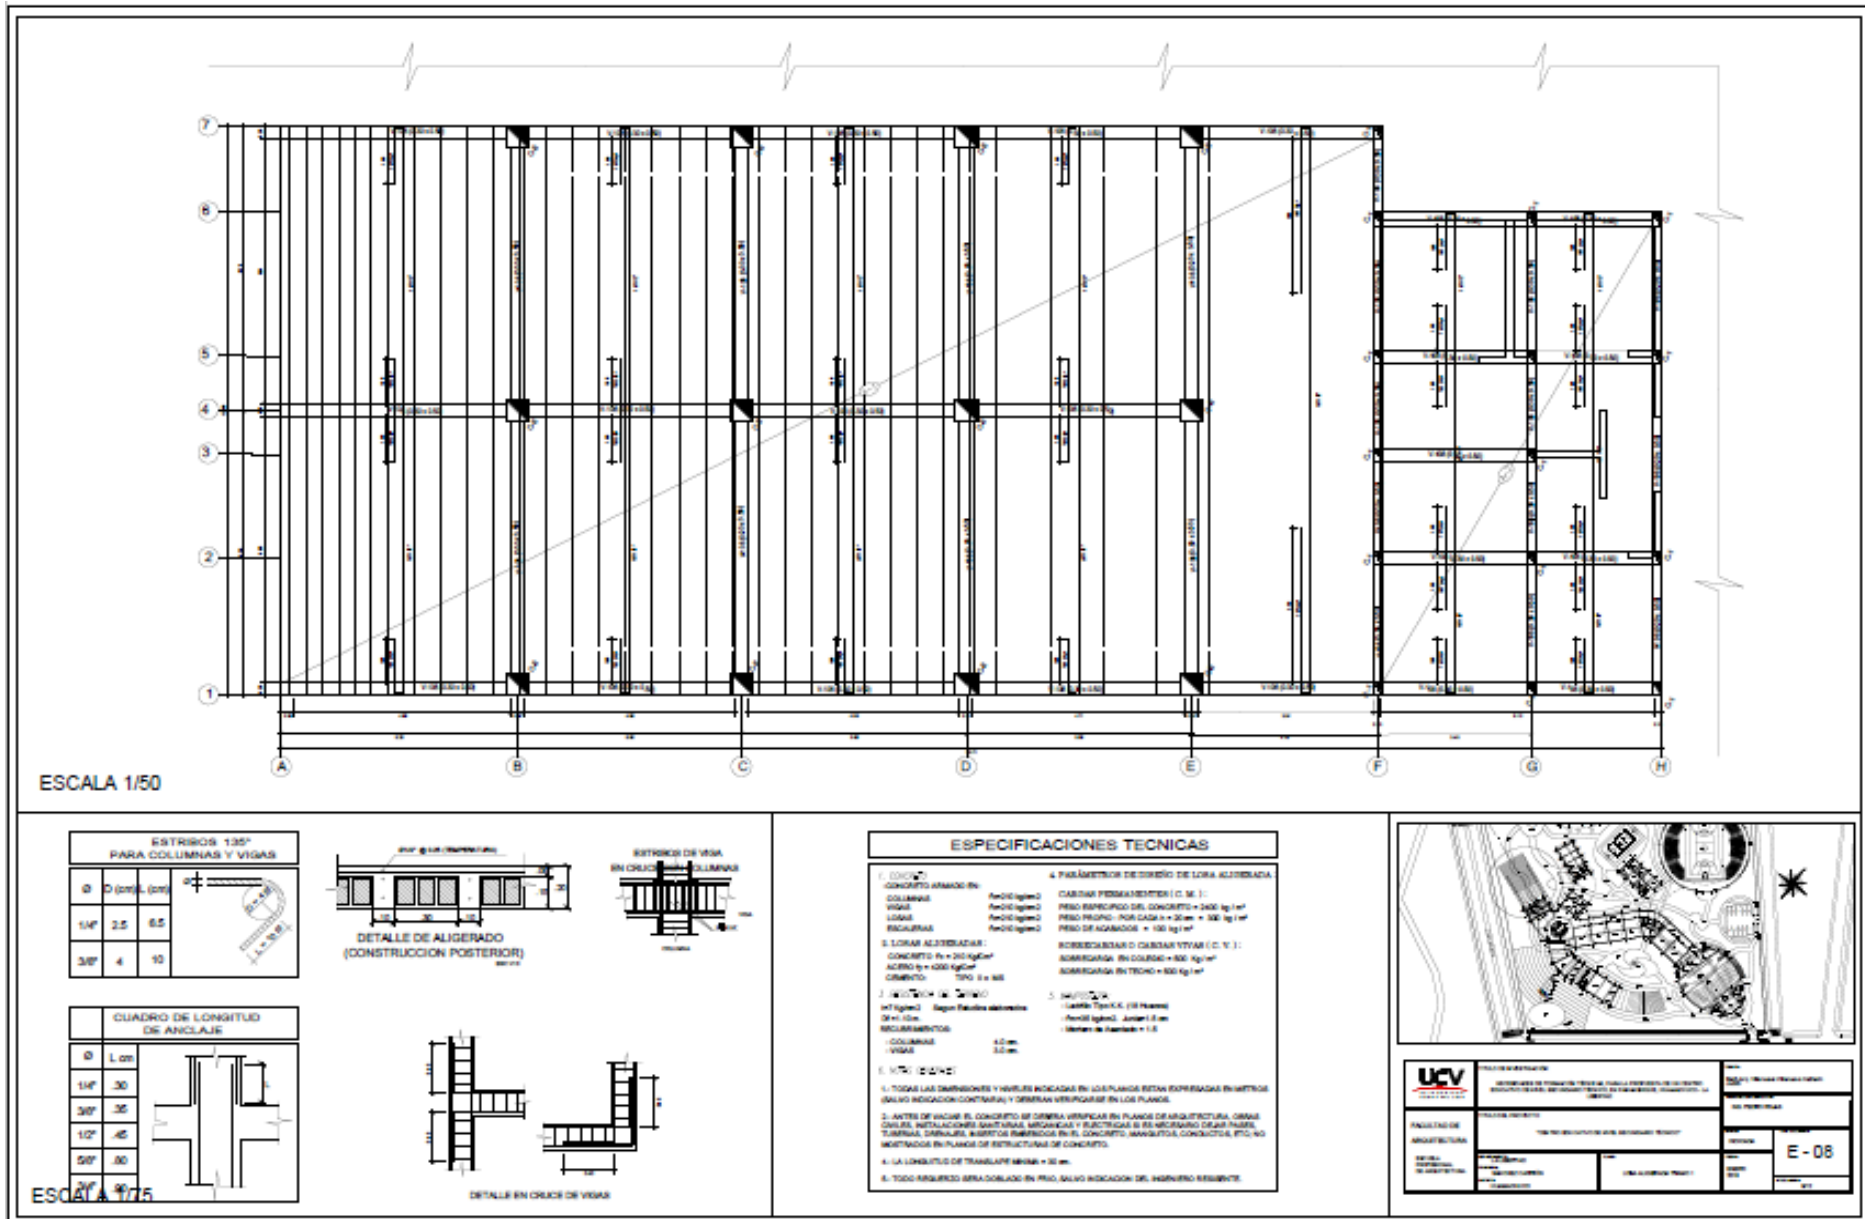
Plano Diseño Estructural Bloque 01 – Losa Aligerada - Plano N° 16 - Lamina E-08
